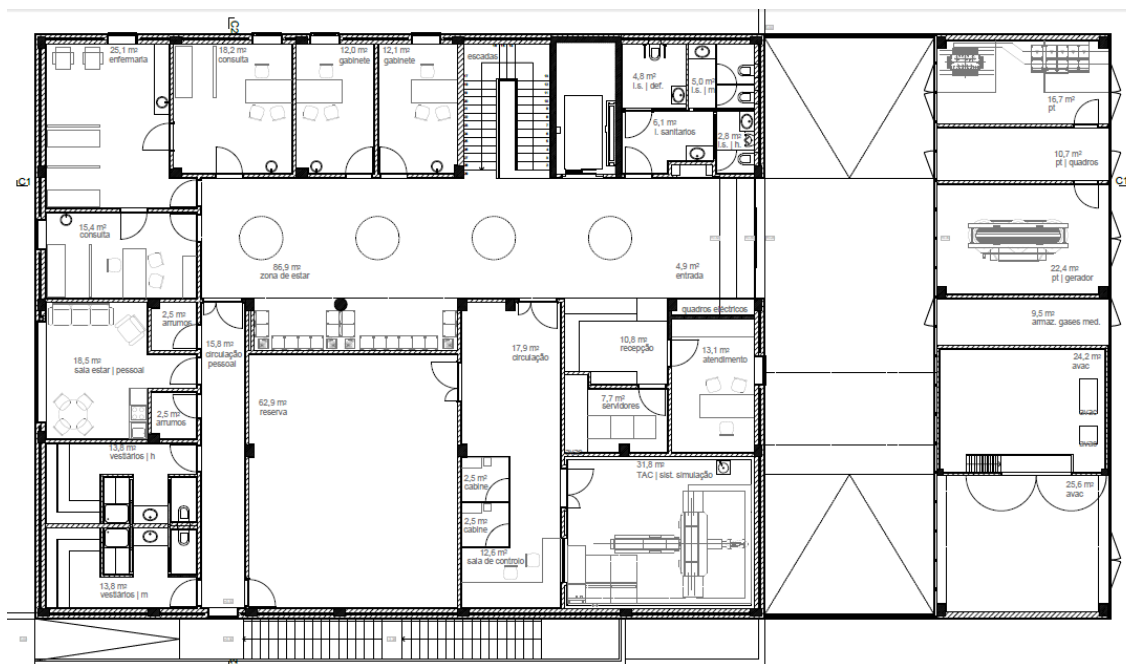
Planta do piso 0 – planta de arquitetura em AutoCad
